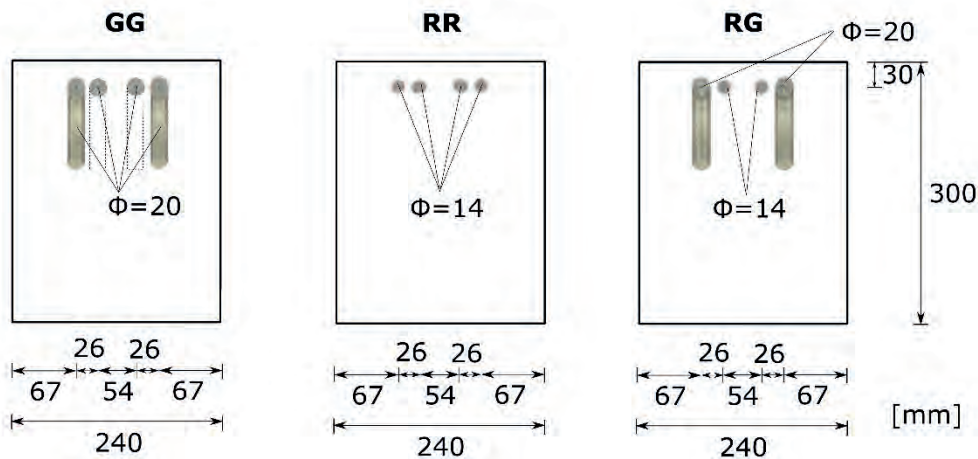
Lage der Stoßbewehrungen im Querschnitt
